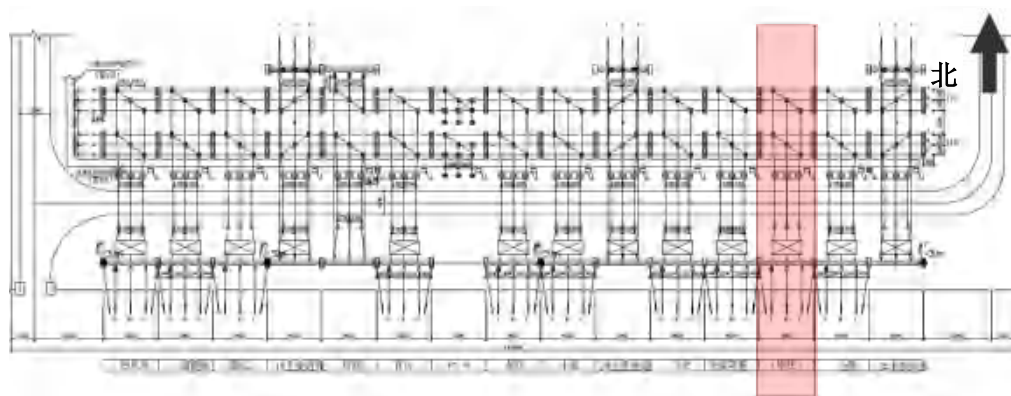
襄城变电站 110 千伏配电装置区平面布置图
